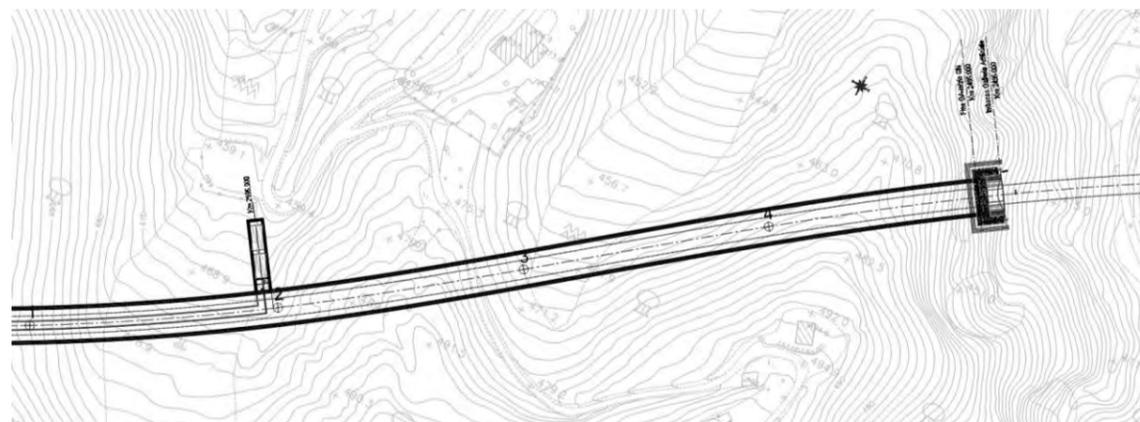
Stralcio planimetrico della galleria "Mercatello 2" – 2° parte
